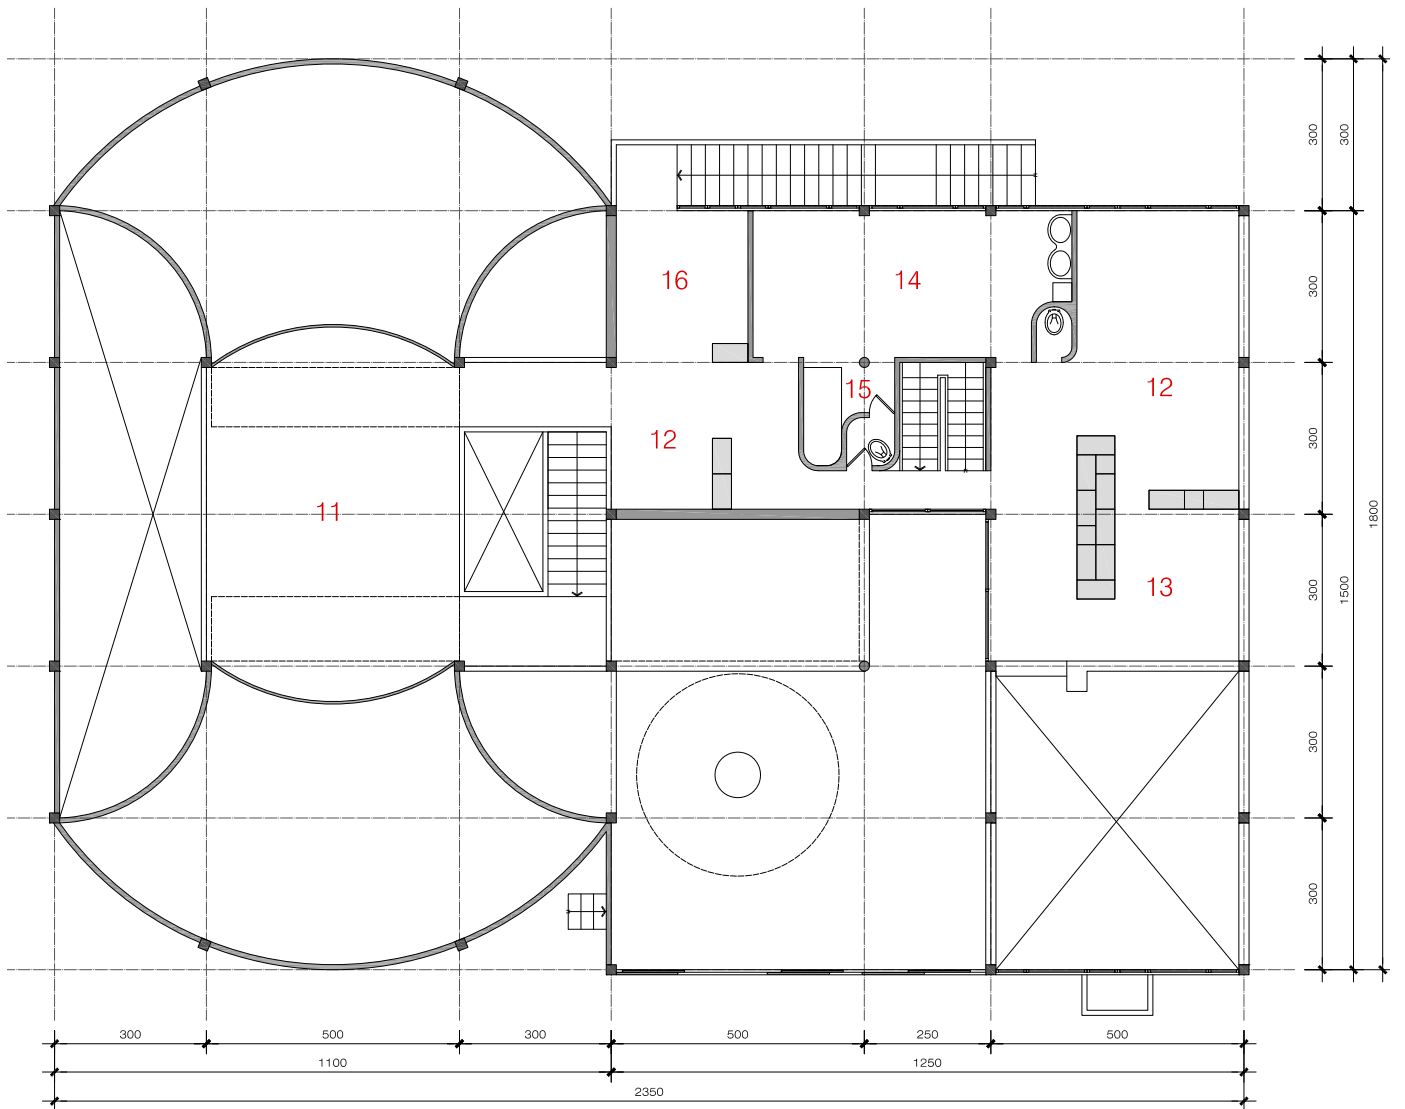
e 30 – Planta Pavimento Térreo e Segundo Pavimento.
